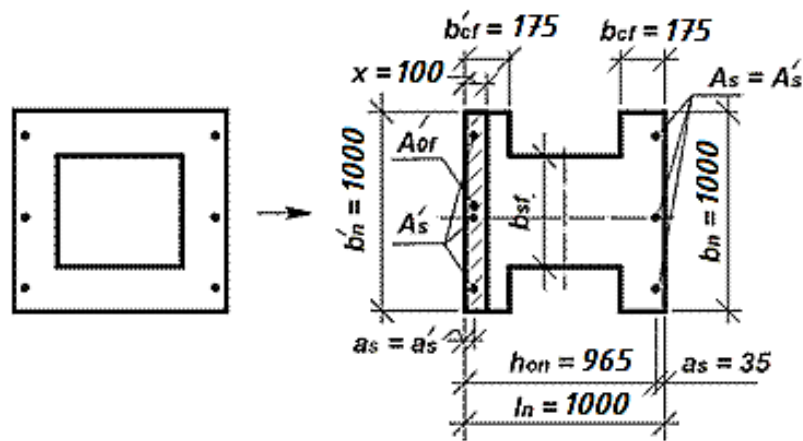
К расчету продольной арматуры подколонника к сечению 3-3
